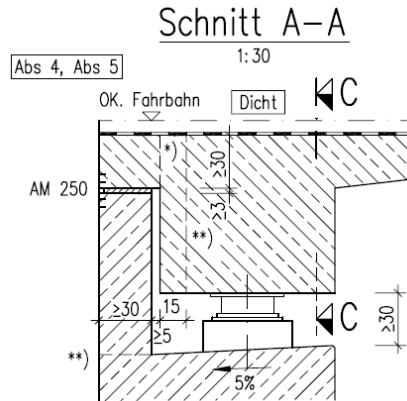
Anschluss Überbau an Widerlager mit Kammerwand, Auflagerbank und Lagerung [17]
